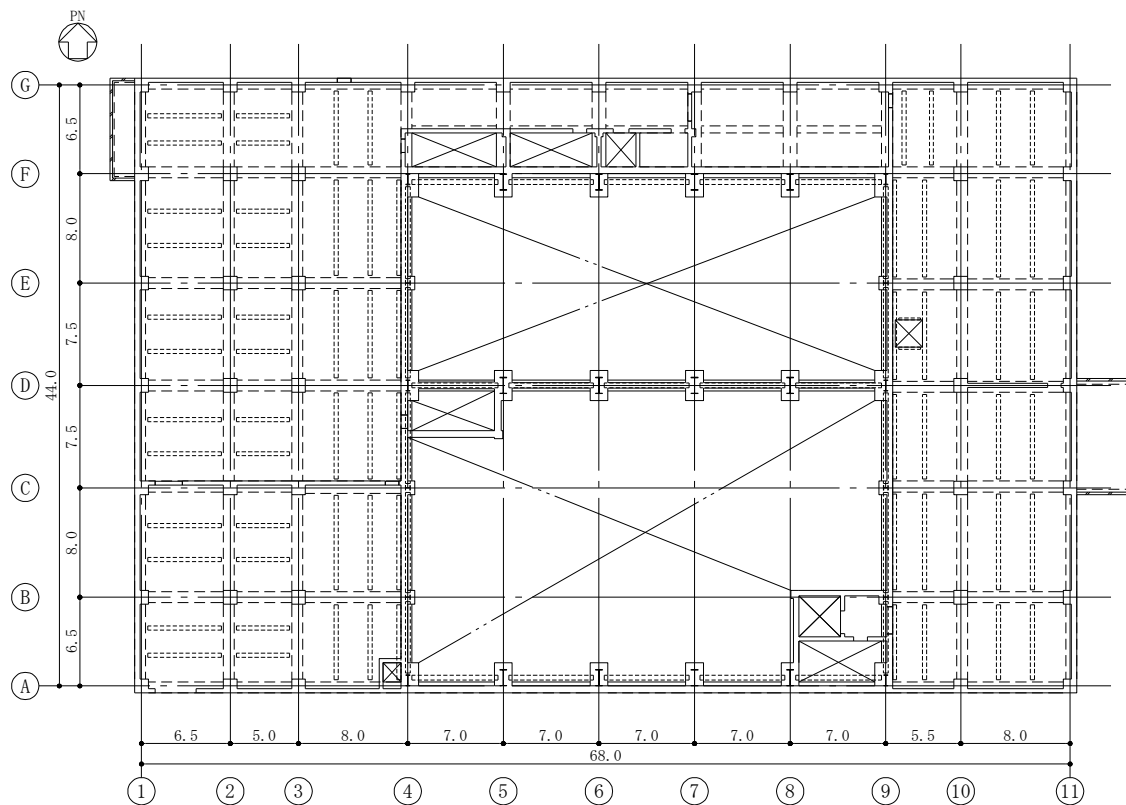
2階平面図 (G.L. +7.8) (単位 : m)
